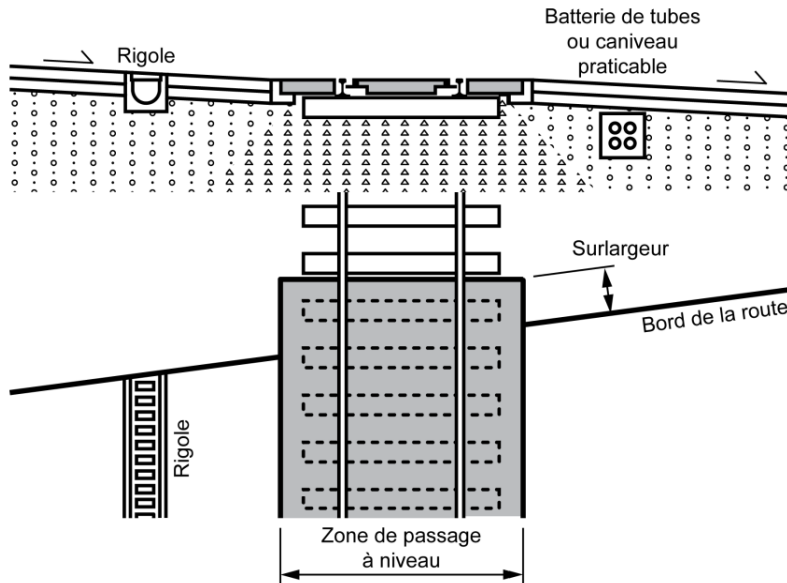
superstructure avec plaques en caoutchouc ou en béton (exemple: section et plan horizontal)
